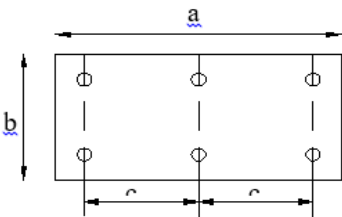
Espacement entre les armatures longitudinales d'un poteau.
